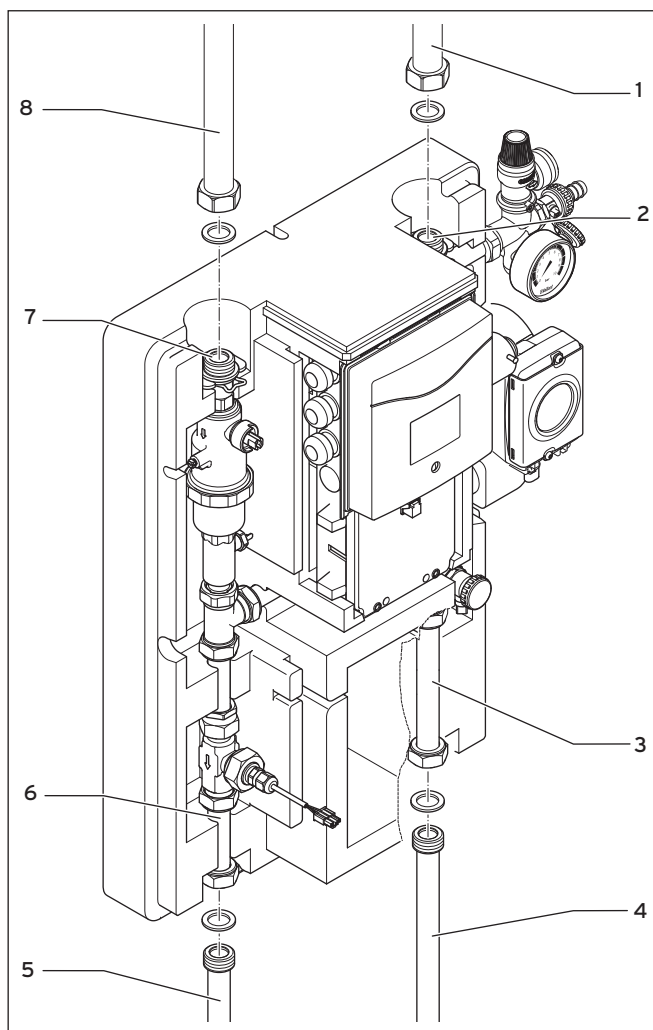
Tubazione di raccordo - montaggio idraulico sul campo di collettori e sul bollitore
